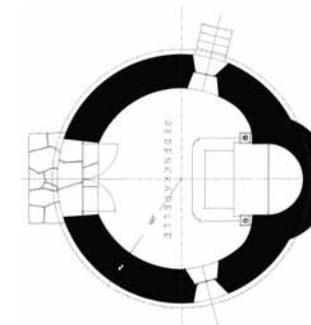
Grundriss Feldkirchen, M 1:200. BDA Planarchives Wien.
